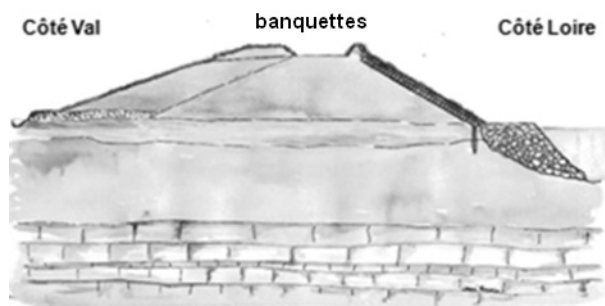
COUPE TRANSVERSALE D'UNE DIGUE-TYPE EN REMBLAI (« LEVÉE »), EN ZONE RURALE OU SUB-URBAINE SUR LE VAL D'ORLÉANS
